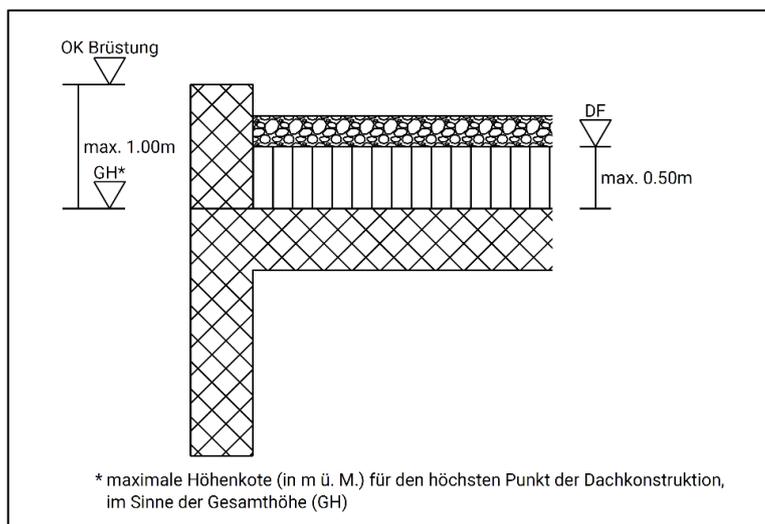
Skizze Messweise der Gesamthöhe (GH), Dachfläche (DF) und Brüstung (OK Br)
